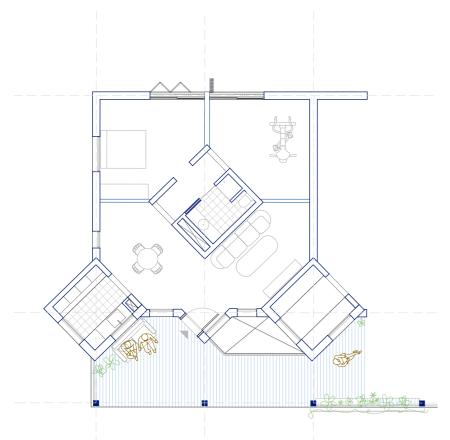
Plano de planta del modelo de vivienda 4H. Elaboración propia
